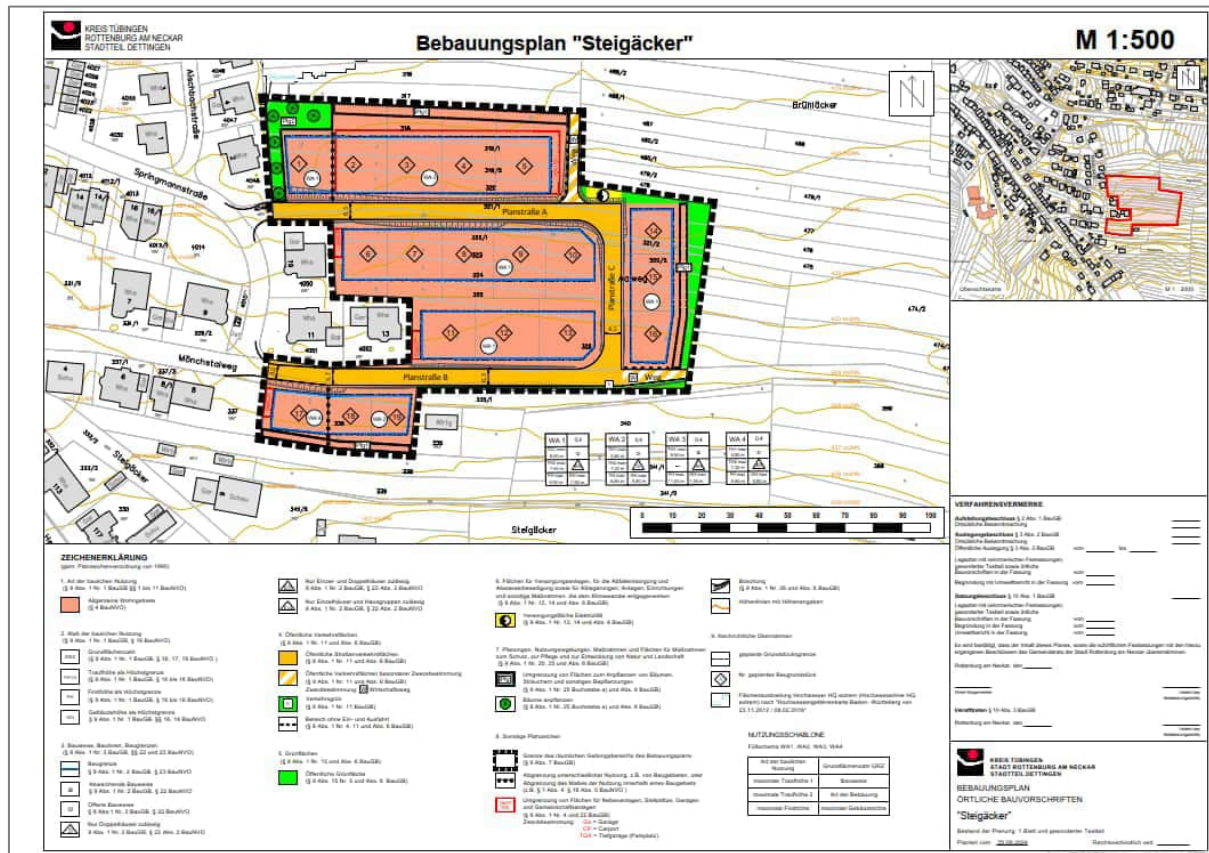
Entwurf Bebauungsplan „Steigäcker“ (Auszug, Stand 25.09.2024)
